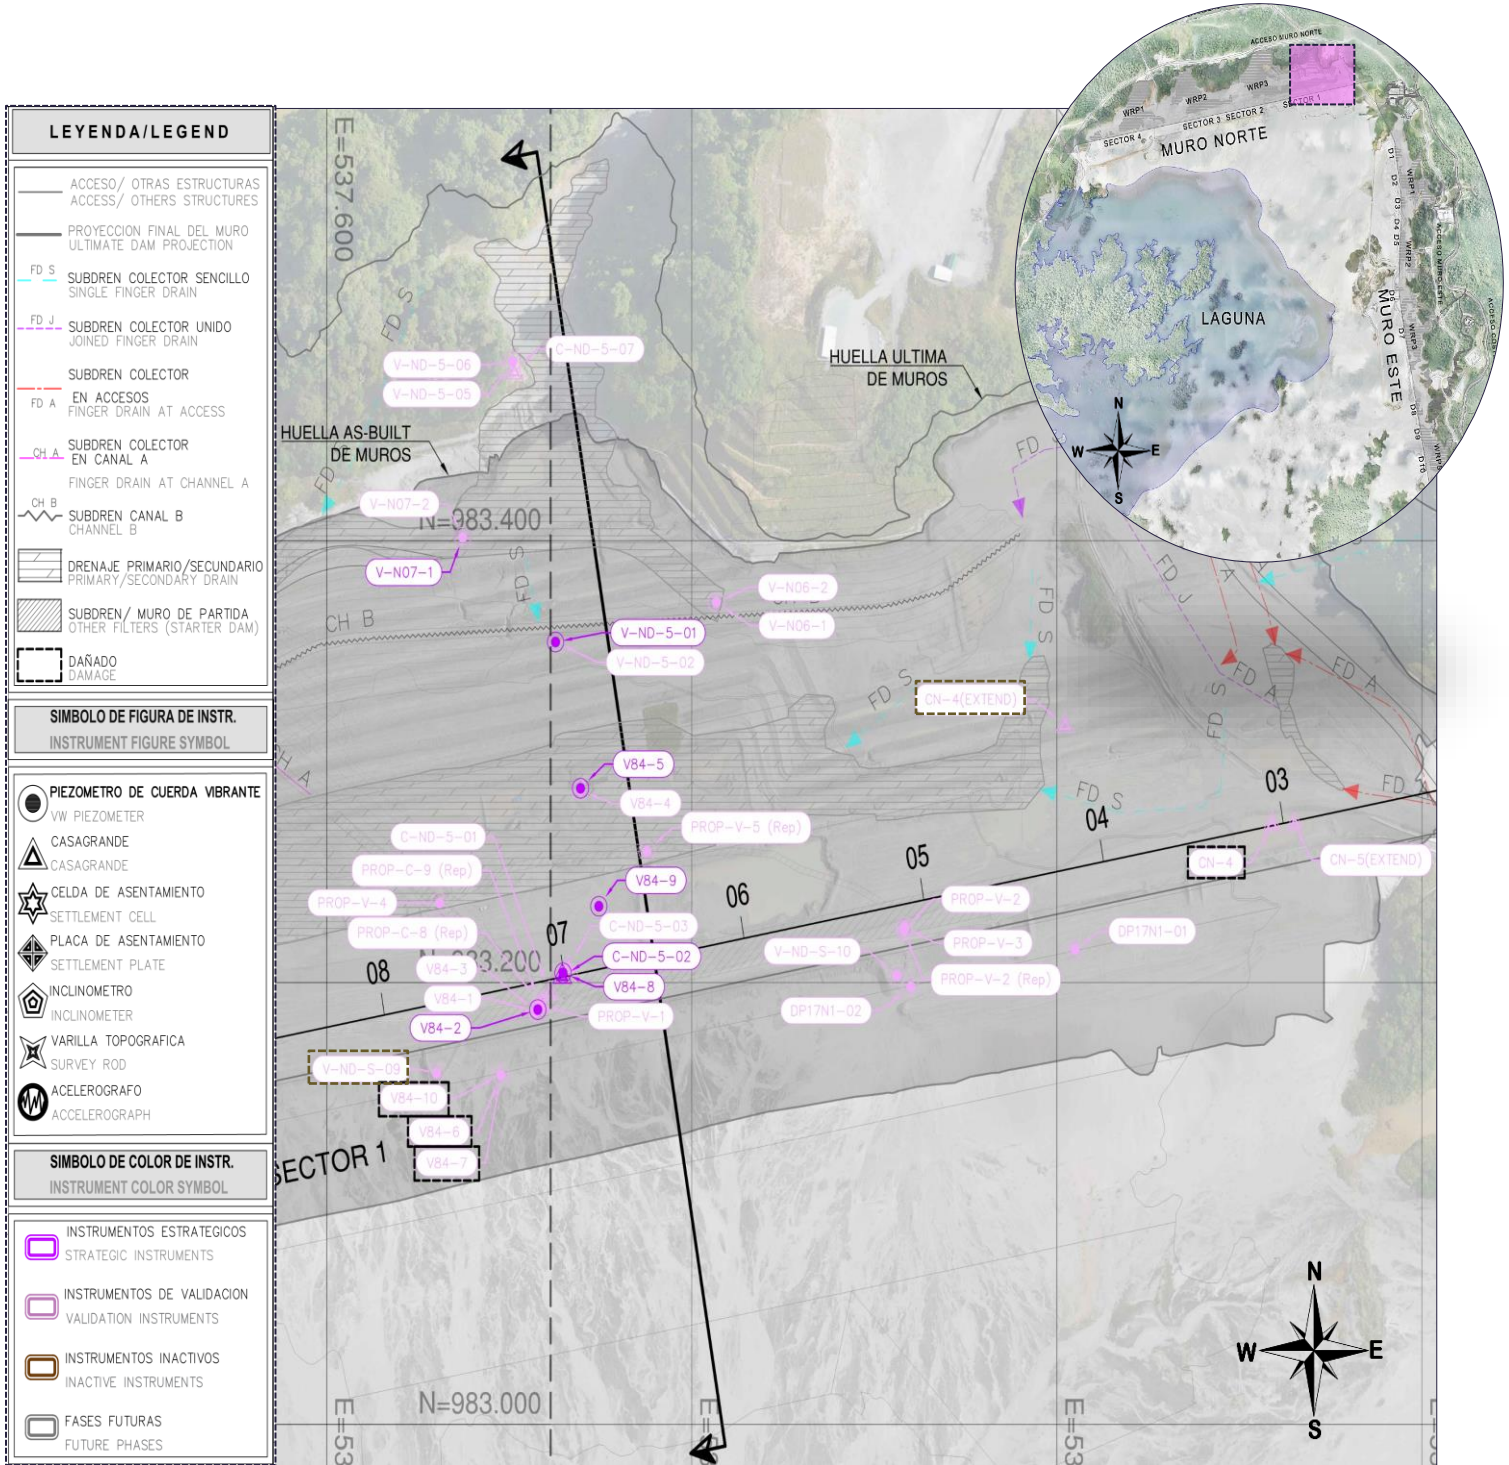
Vista de Planta en Muro Norte Sector 1 - Esquina Noreste (N/E) con Piezómetros
